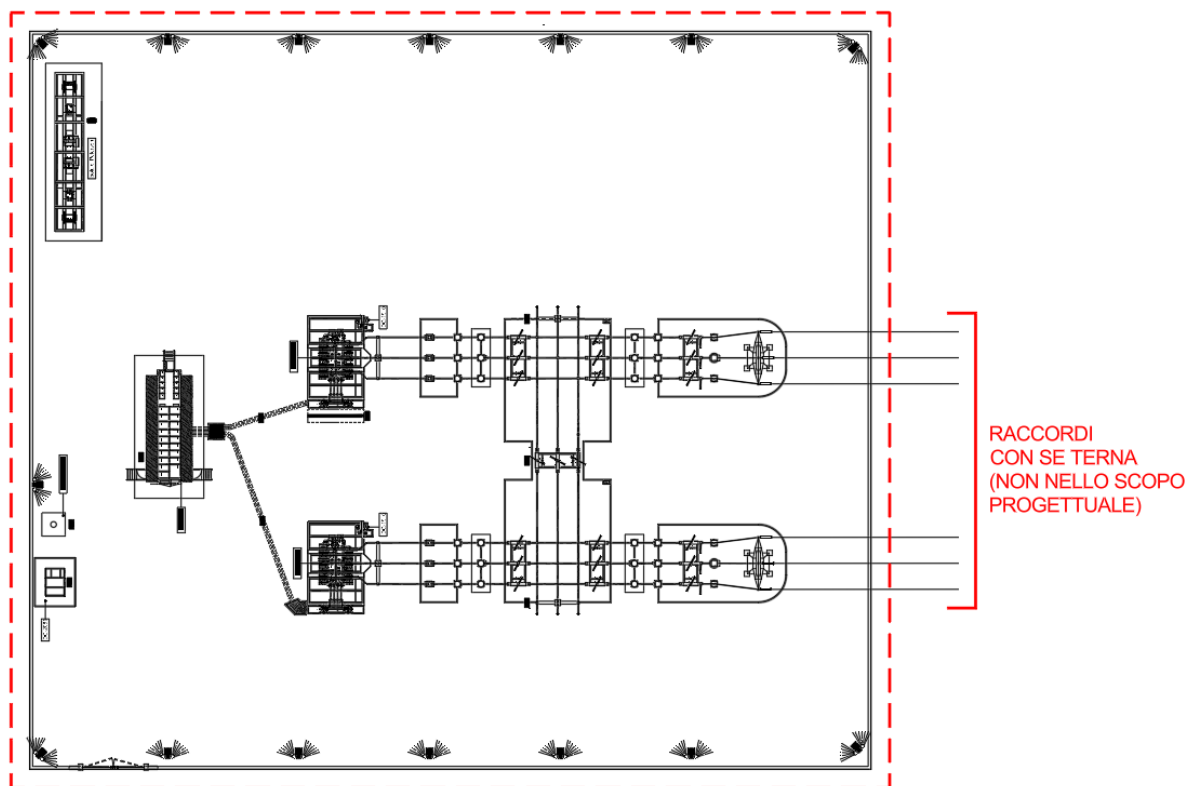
Planimetria Elettromeccanica Cabina Primaria di progetto
